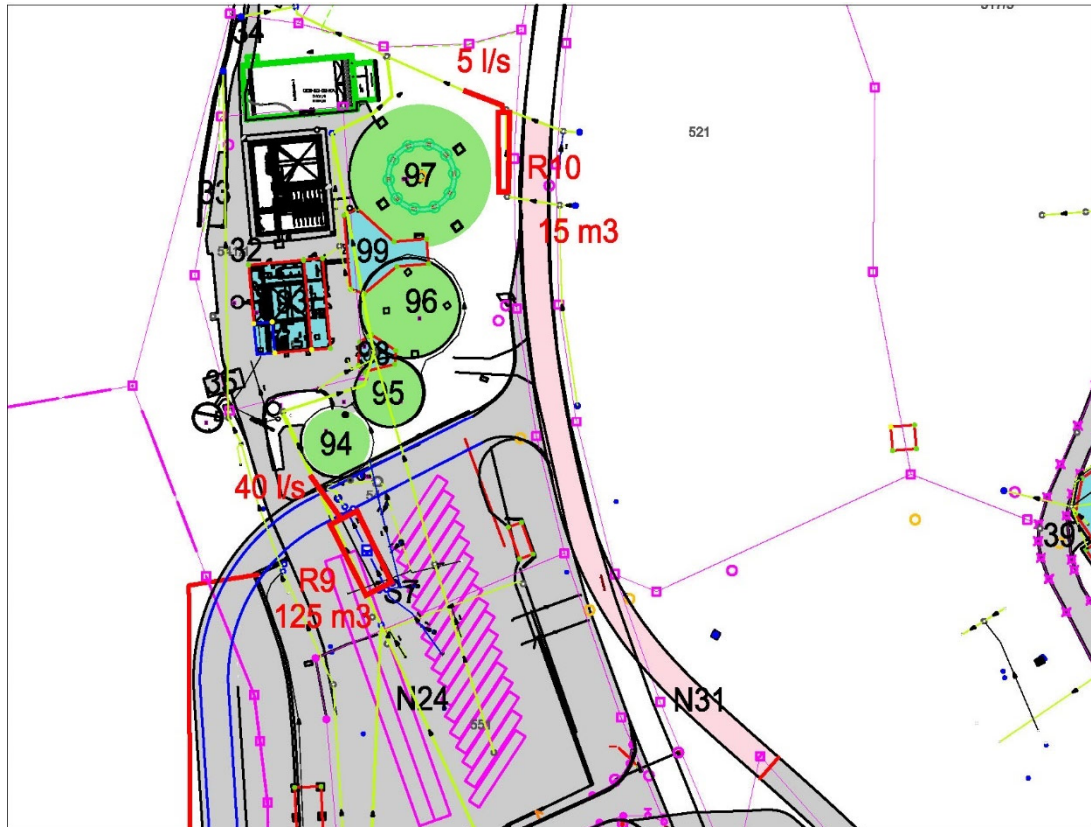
Flächenanteil für R10 – Rückhaltebecken bei Kreisstraße Kr TS 3 Nord mit Ableitung in Schlagbach
